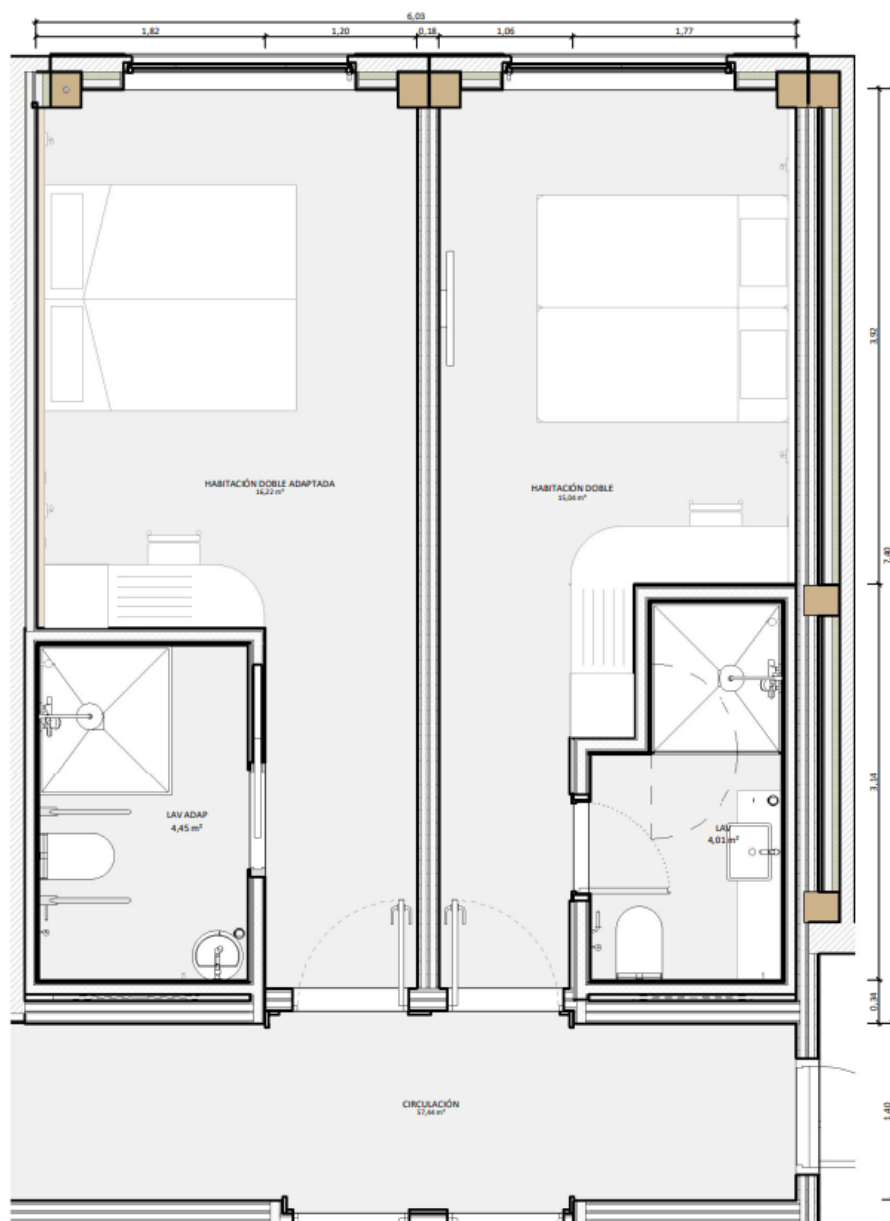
Planta de um quarto simples e adaptado - Hotel "Tres Cantos" em Madrid (sem escala)
